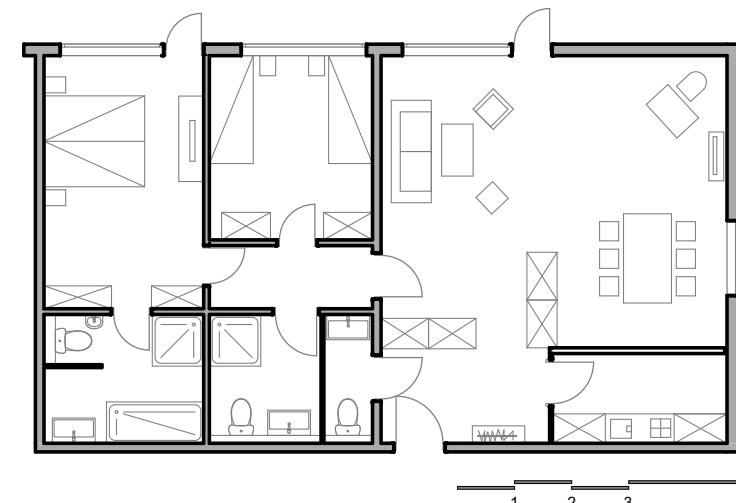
Planta Tipo Suit, Dibujada por el autor.
